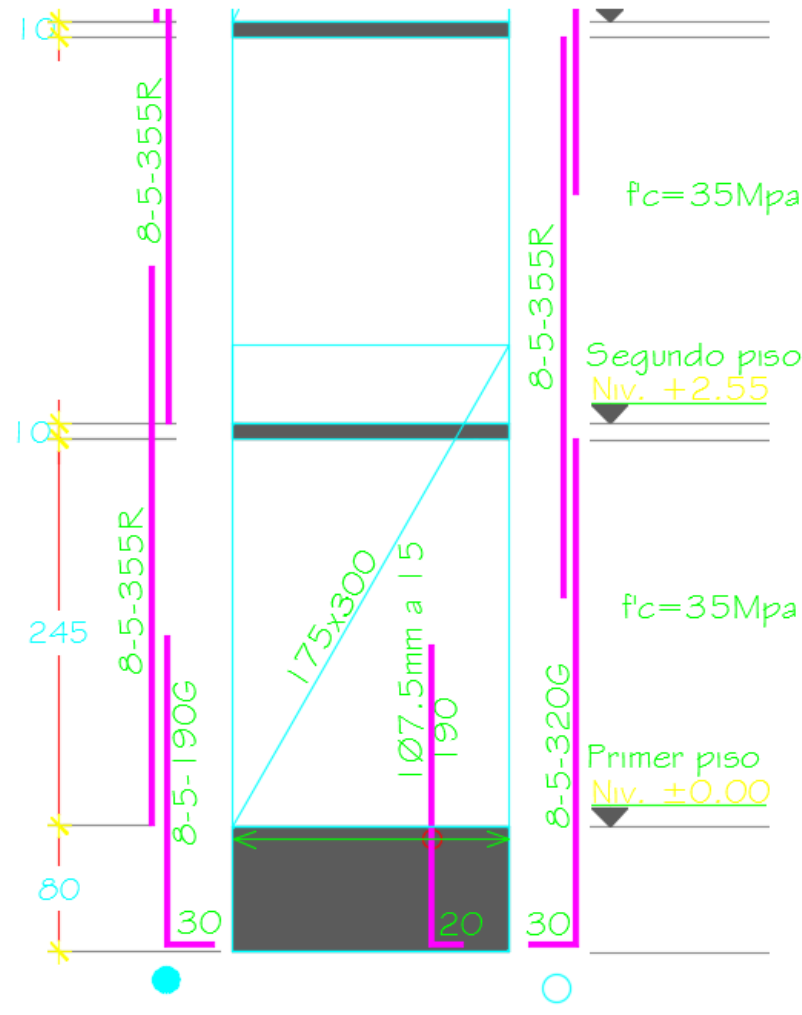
Acercamiento del plano de alzadas de un muro del primer piso de la torre D.
